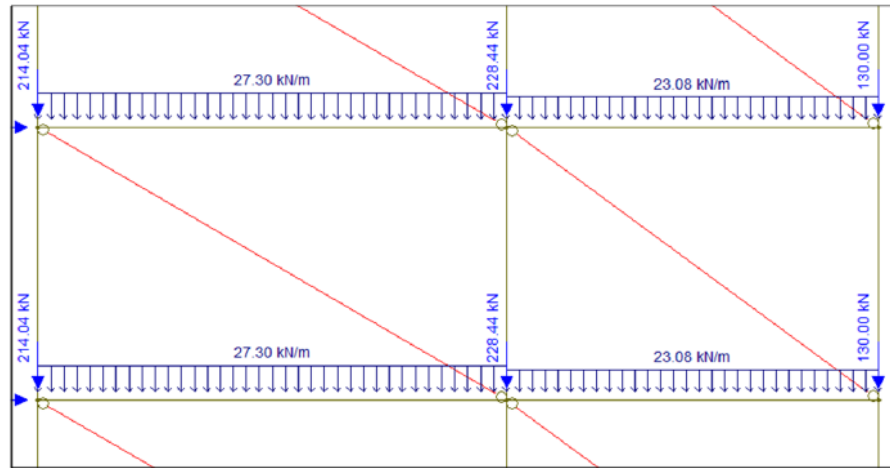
Pórtico completo com a ação do vento e cargas horizontais
